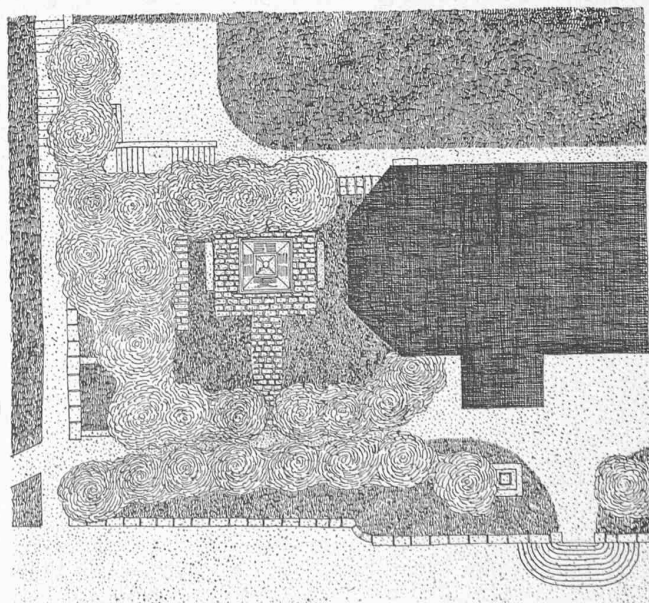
Lageplan der beiden Denkmäler bei der Kirche Langnau. — 1:500.
